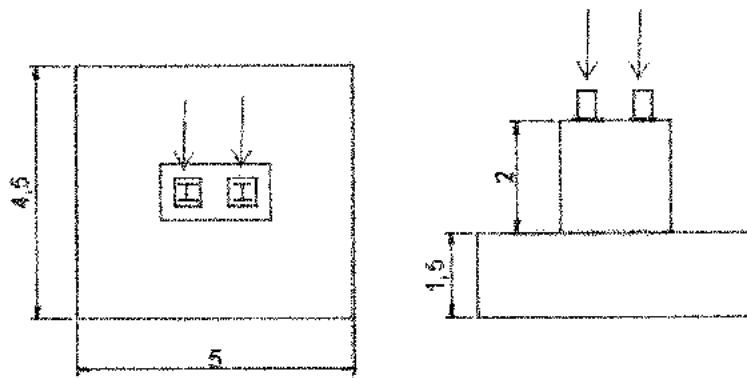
Pianta e sezione trasversale del plinto e pilastro di fondazione
